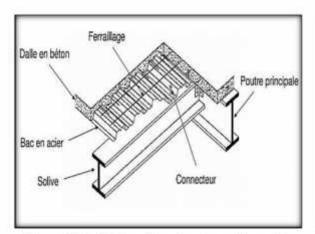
Schéma d'un plancher collaborant source:notech.franceserv.com/planchers.html
